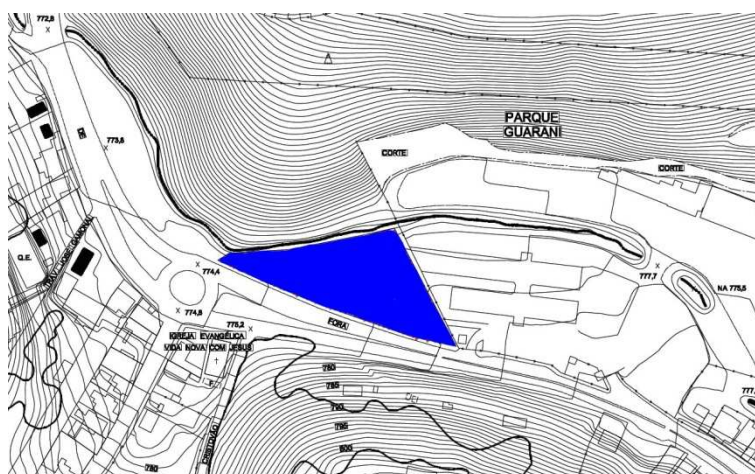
Localização da Área 12 - Bairro Parque Guarani.
